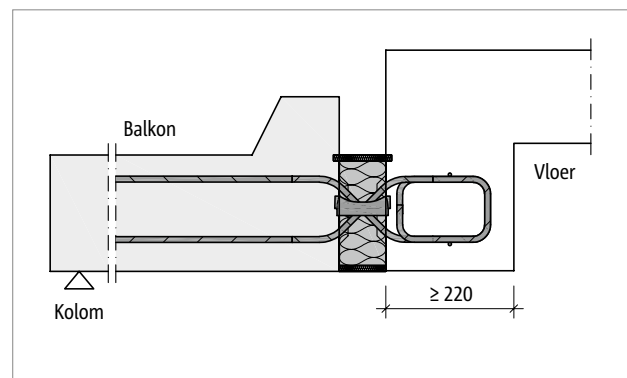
Schöck Isokorf® T type Q-E-W-V: Plaatselijke aansluiting
